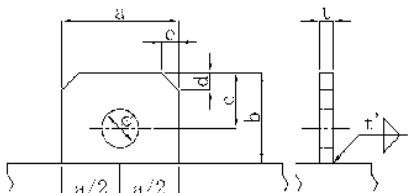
鋼管杭の半自動溶接現場継手標準形状寸法
